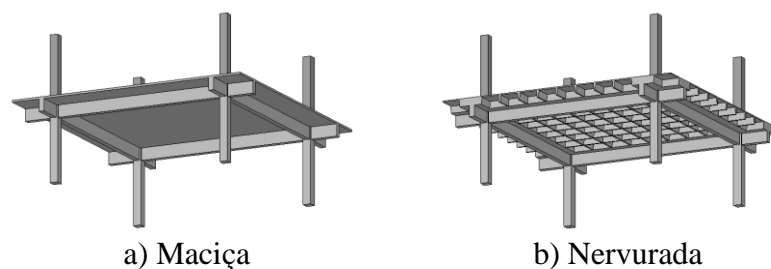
Lajes sobre vigas [adaptado – FERREIRA (2010)]
